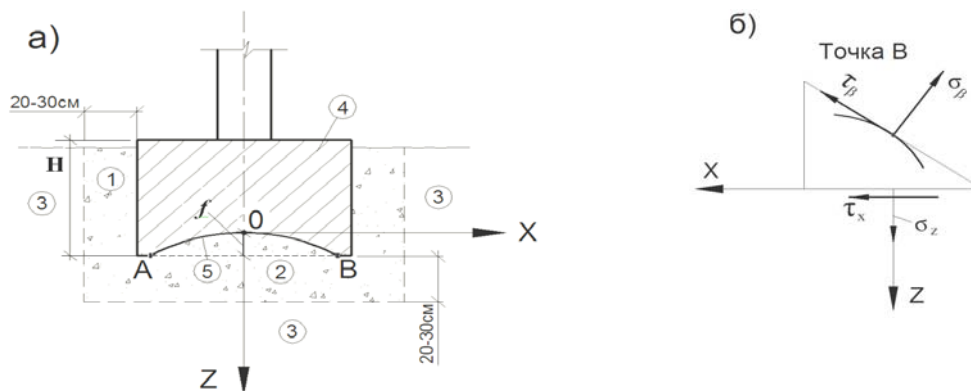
Конструкция фундамента вогнутой подошвой с сейсмоизолирующим песчаным слоем а) 1-песчаный экран, 2-песчанная подушка, 3-надежное основание, 4-фундамент вогнутой подошвой, 5-вогнутая поверхность подошвы фундамента ( $f=1/3-1/2$  от  $H$ , где  $f$  – высота стрелы свода и  $H$  – высота фундамента); б) расчетная схема для определений напряжений под вогнутой подошвы фундамента.
